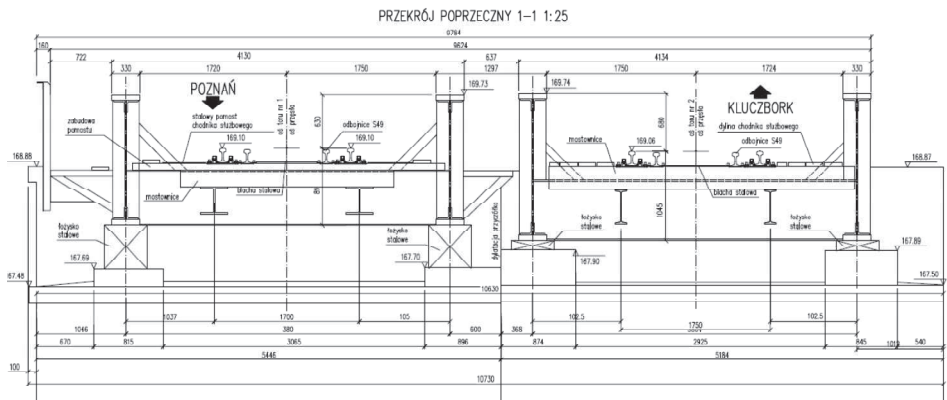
Przekrój poprzeczny (stan przed remontem) – km 0,227
